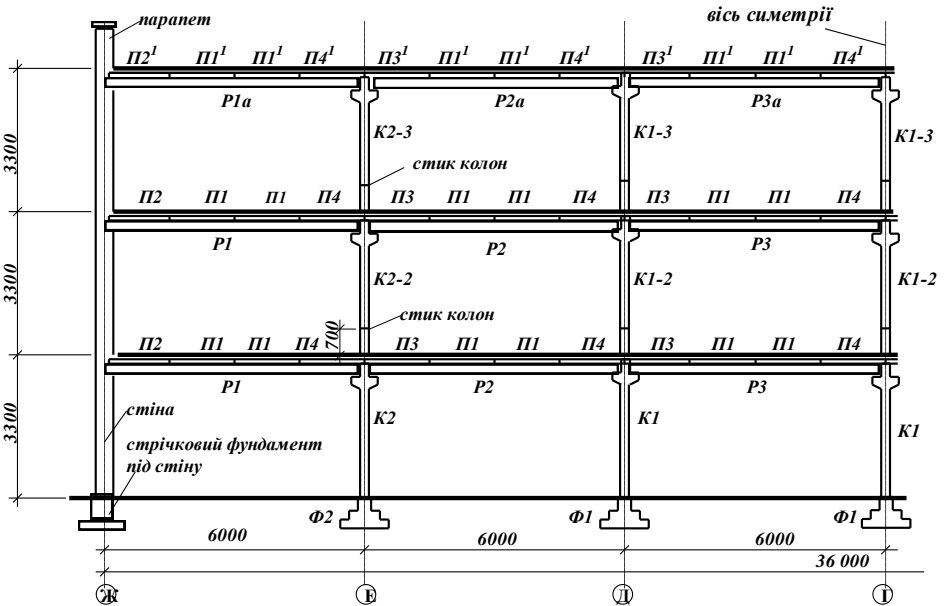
Поперечний розріз будівлі А-А (половина) з маркуванням збірних елементів
